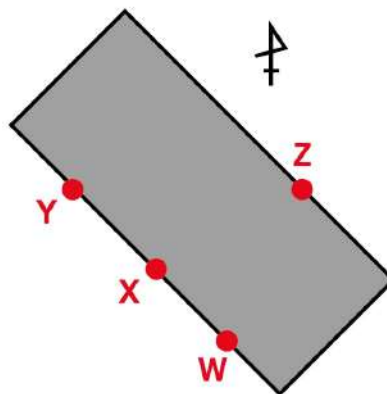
Shoot_2-1pとShoot_2-2xのひび割れ幅計測ポイント位置図
